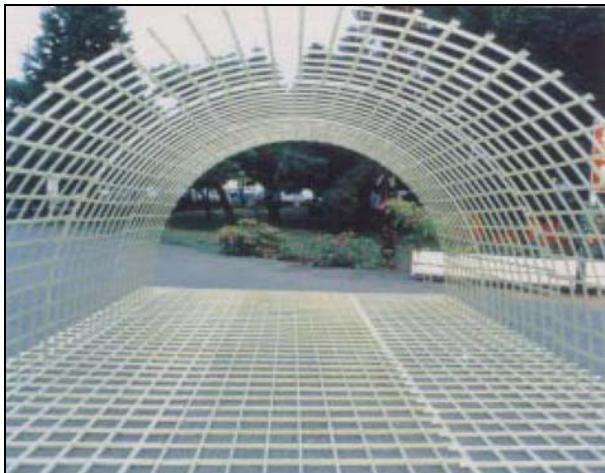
Rejilla de GFRP para armado de túnel y vista de posterior aplicación.
